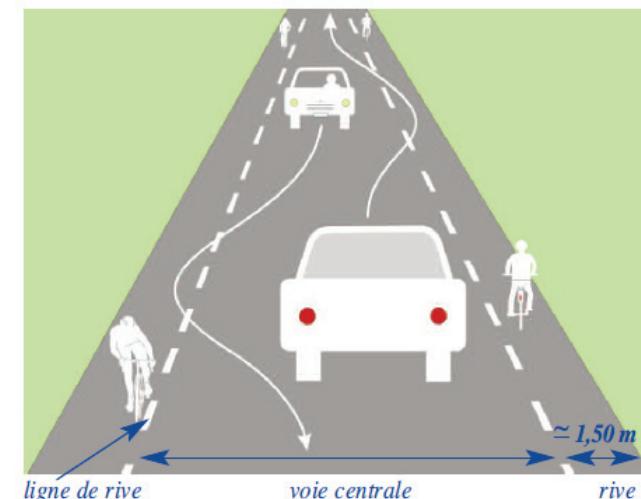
Schéma d'une chaussée à voie centrale banalisée
